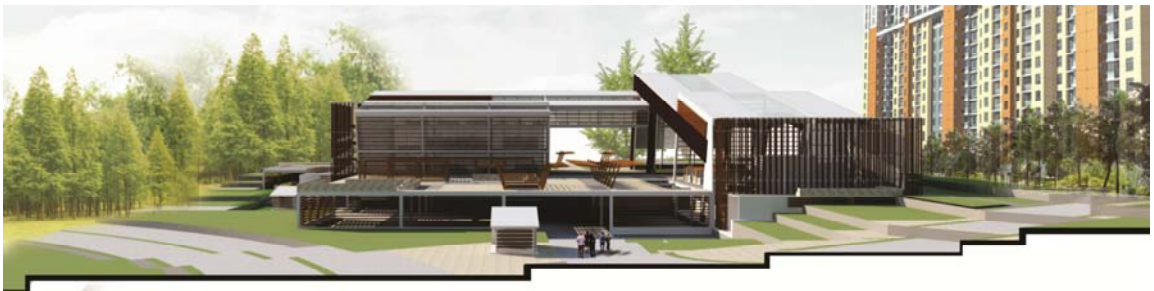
Fachadas _ fachada este. Fuente: elaboración propia.
